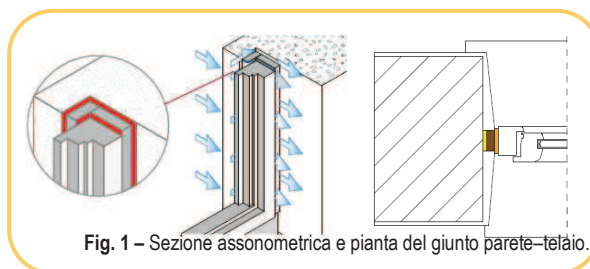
Sezione assometrica e pianta del giunto parete-telaio.
